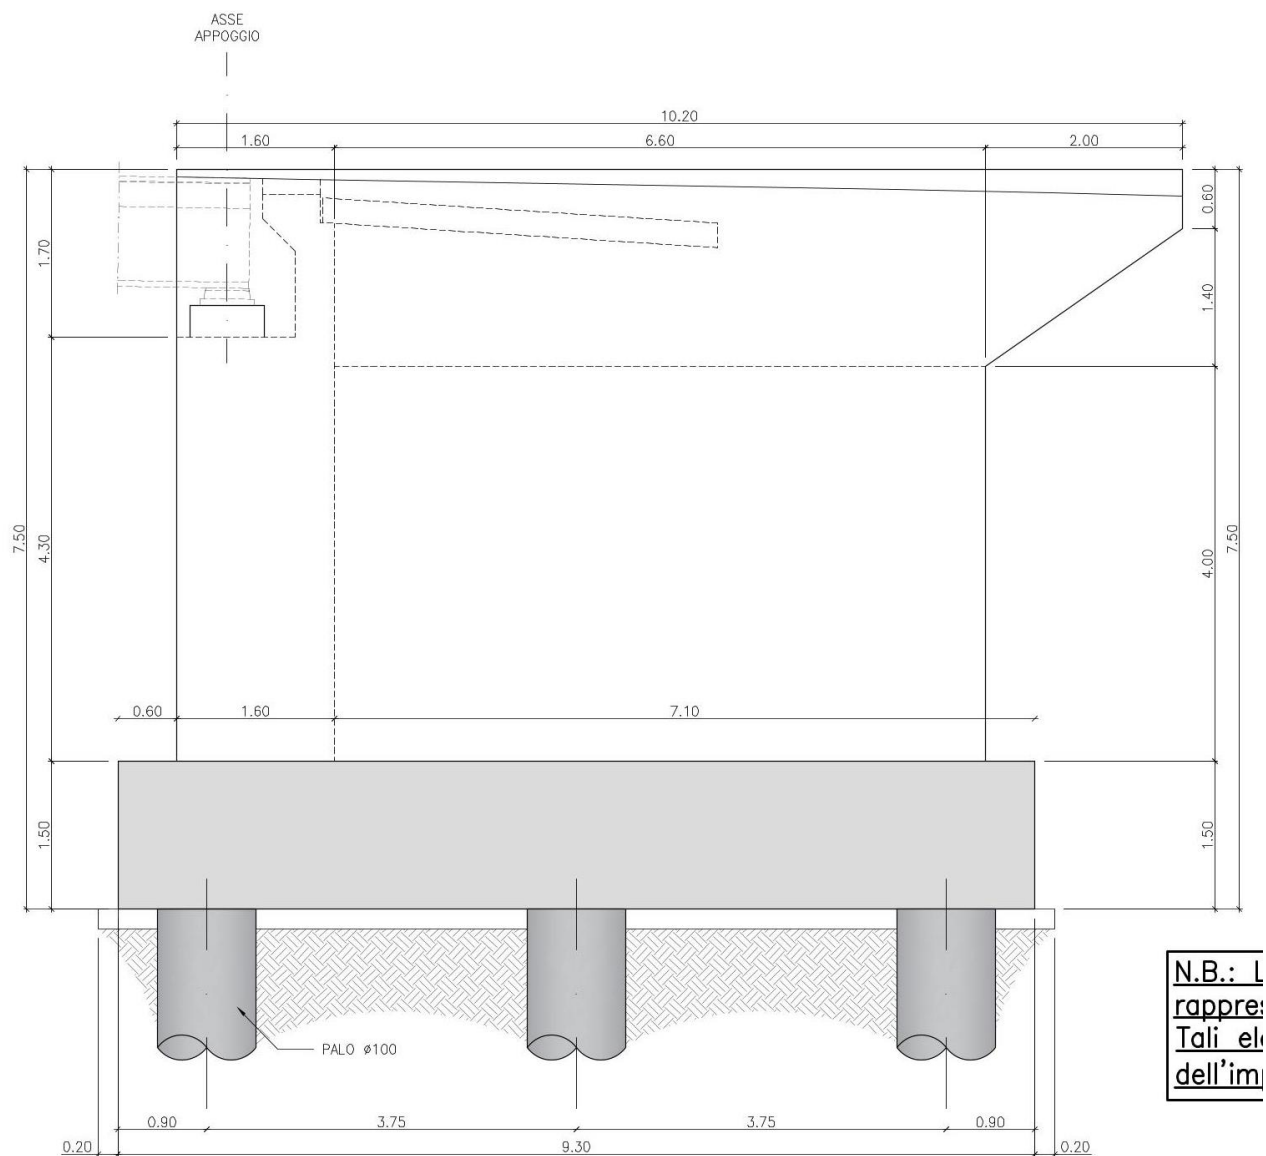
Sezione longitudinale Carpenterie Spalle
